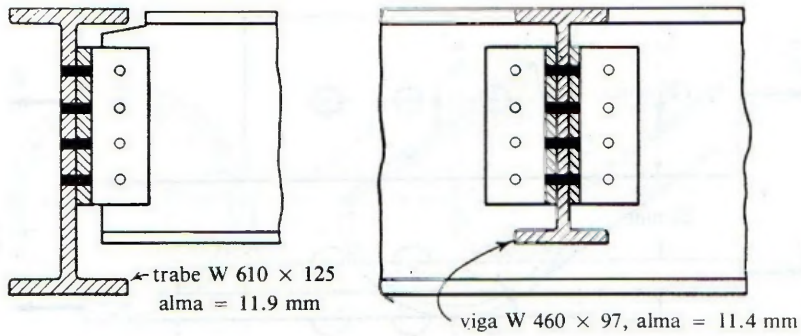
Detalles de la unión de una viga y una trabe o viga maestra.
